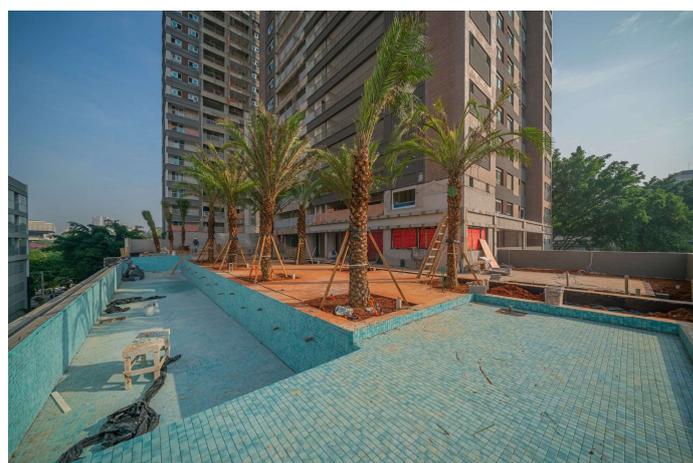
Fase de acabamentos e paisagismo em área comum.
